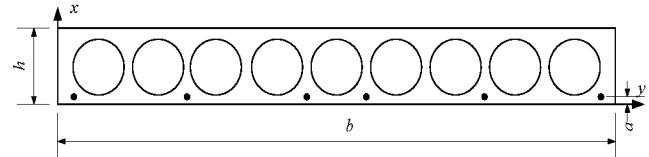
Багатопустотна залізобетонна плита перекриття, що рівномірно нагрівається по всій поверхні під час пожежі в приміщенні
